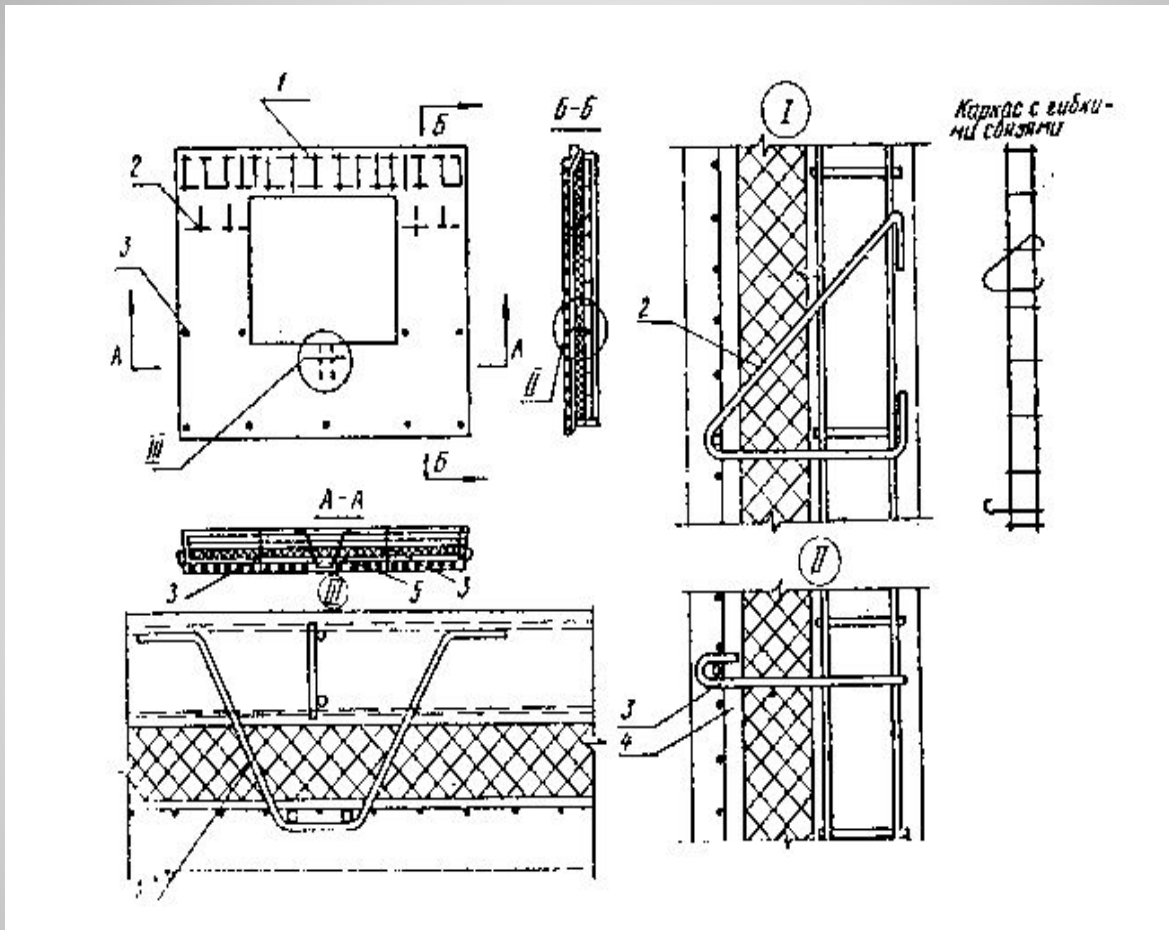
Схема армирования трехслойной панели с гибкими связями из отдельных стержней:
